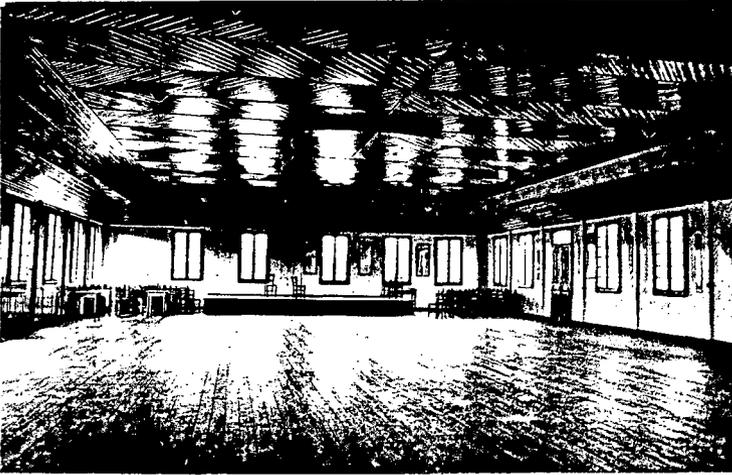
Clube 25 de julho. Salão de Bailes. cobertura com 14 m de vão. Forro elaborado, com elementos vazados de ventilação.
